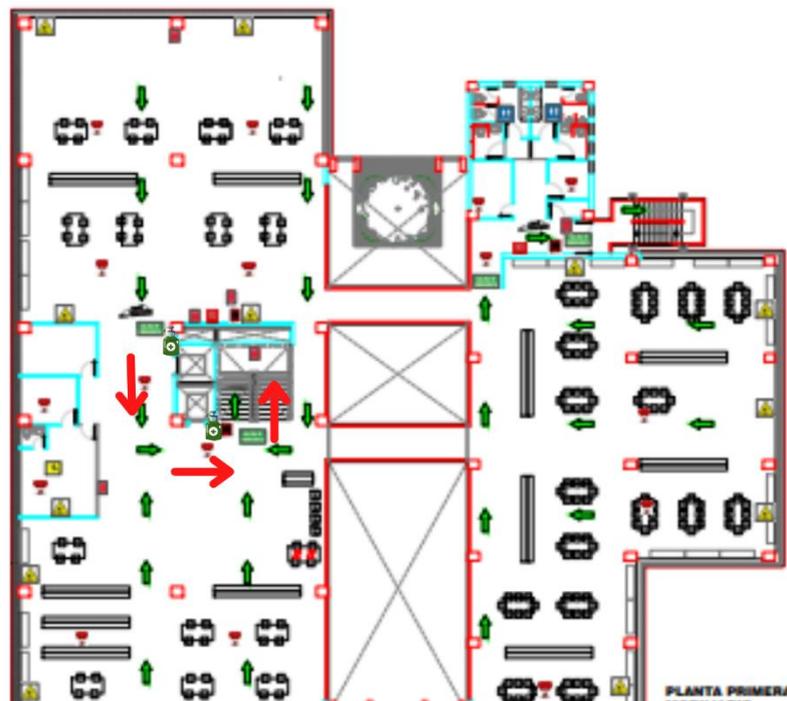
RUTA RECOMENDADA PRIMERA PLANTA ALTA CRAI
